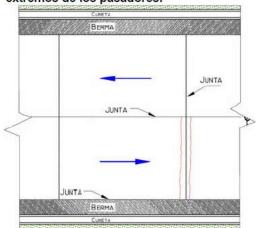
Vista en planta de grietas en los extremos de los pasadores.
